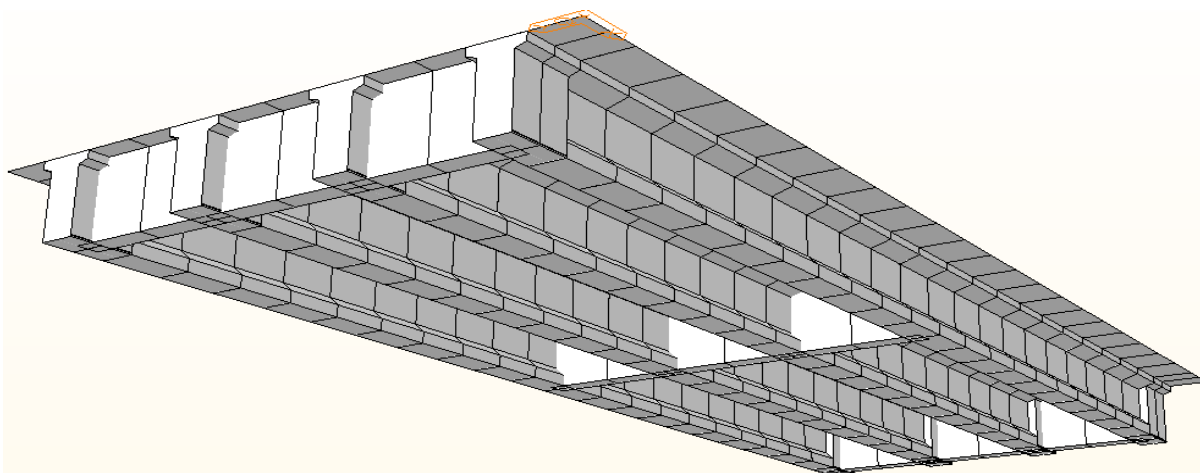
Divisão das vigas principais e secundárias em elementos de barras.
